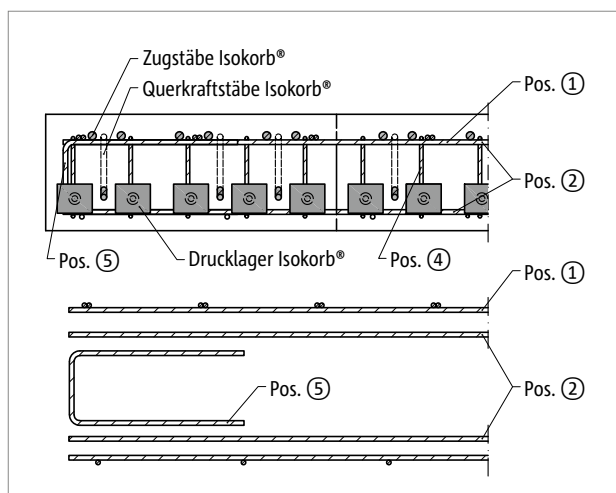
Schöck Isokorb® XT Typ K-M11: Bauseitige Bewehrung balkonseitig im Schnitt A-A; Pos. 5 = konstruktive Randeinfassung am freien Rand
